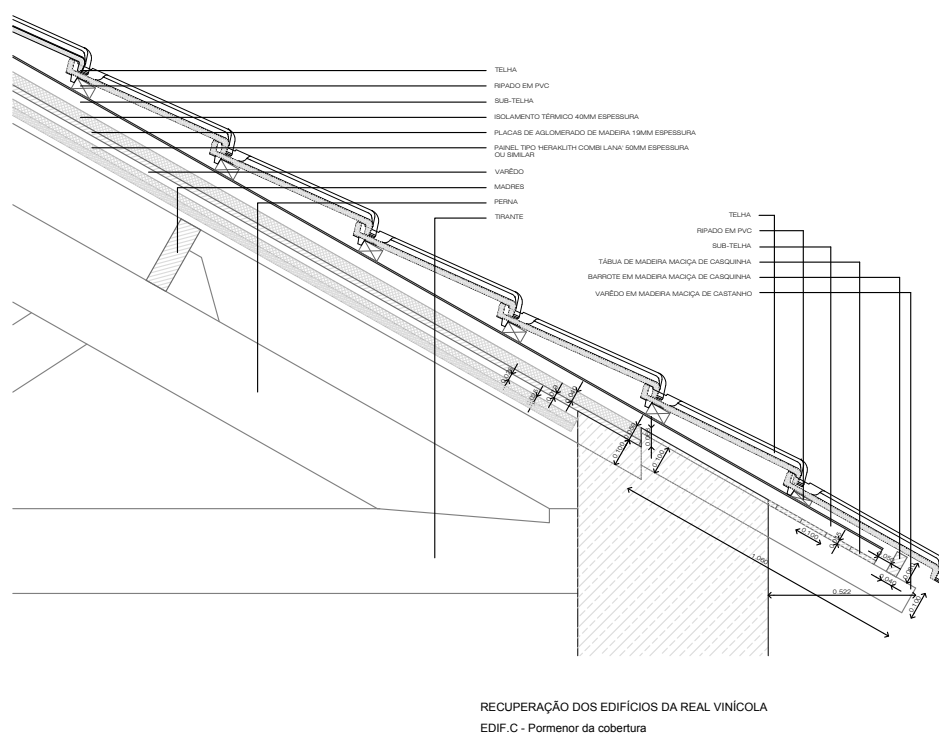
Pormenor construtivo da Casa da Arquitetura (fonte: Arquiteto Guilherme Machado Vaz⁹¹)
